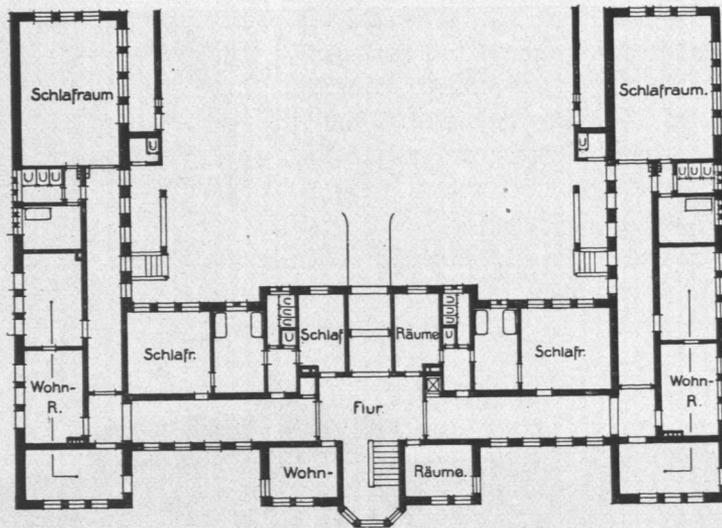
Alsterdorfer Anstalten, Bodelschwinghaus, Erdgeschoß, Grundriß.
